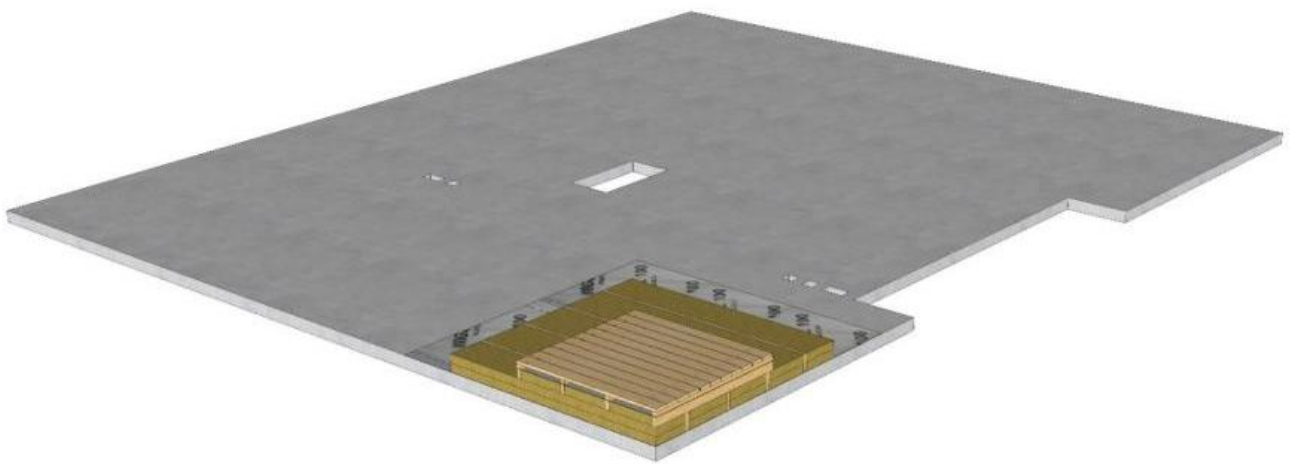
Аксонометрична схема збірного залізобетонного перекриття однородинного будинку із круглопустотних плит (рисунок автора)
